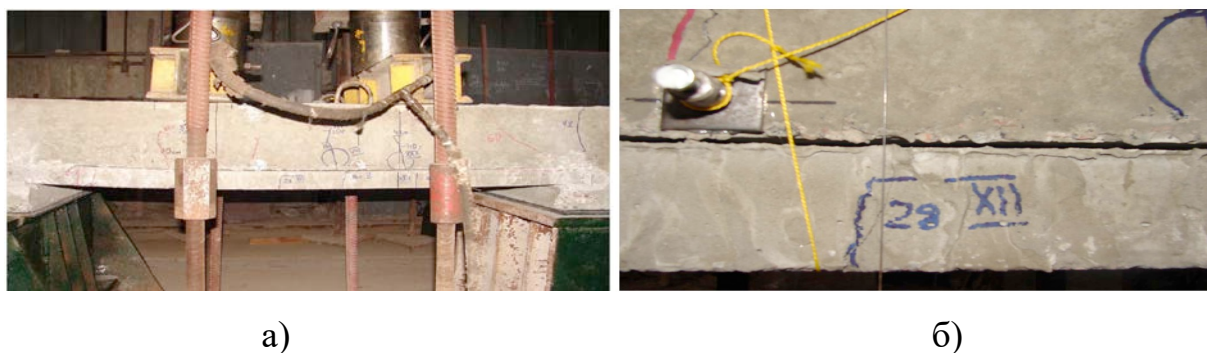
Відшарування опалубочної плити ПО-1 від монолітного бетону
